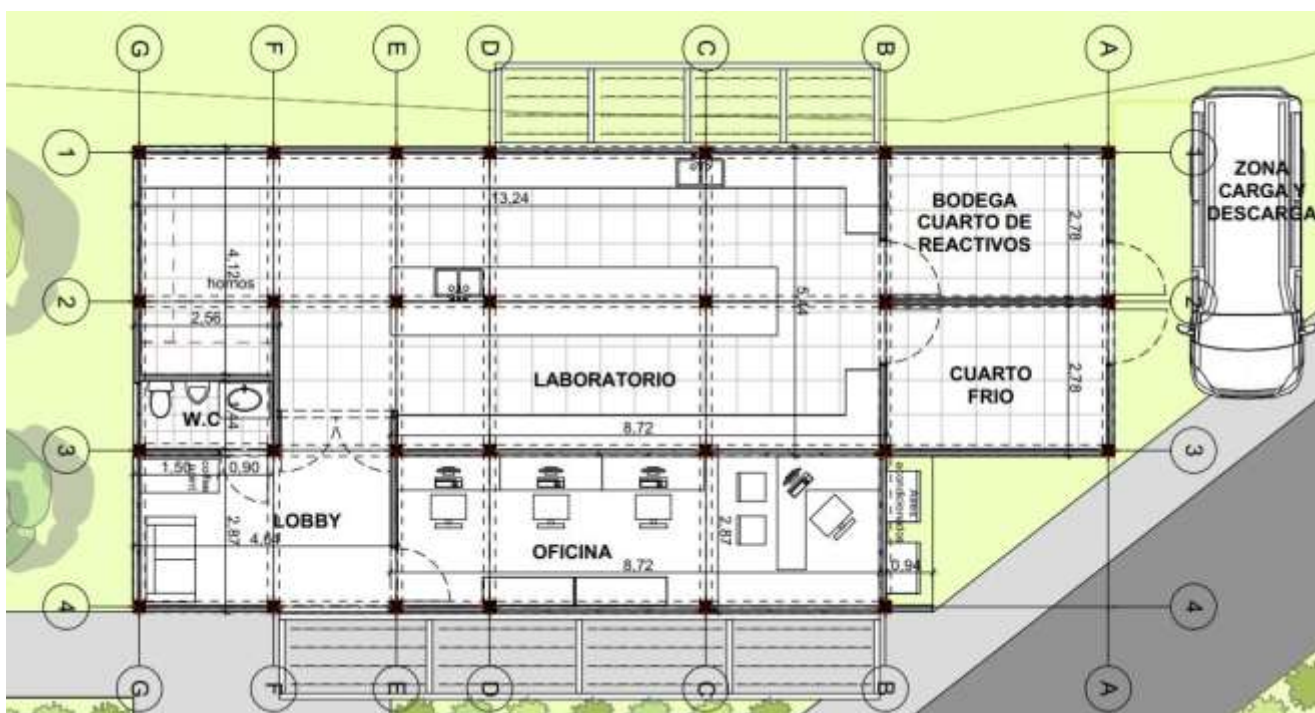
Planta de distribución arquitectónica y ejes constructivos. Fuente: Elaboración propia ArchiCAD.
